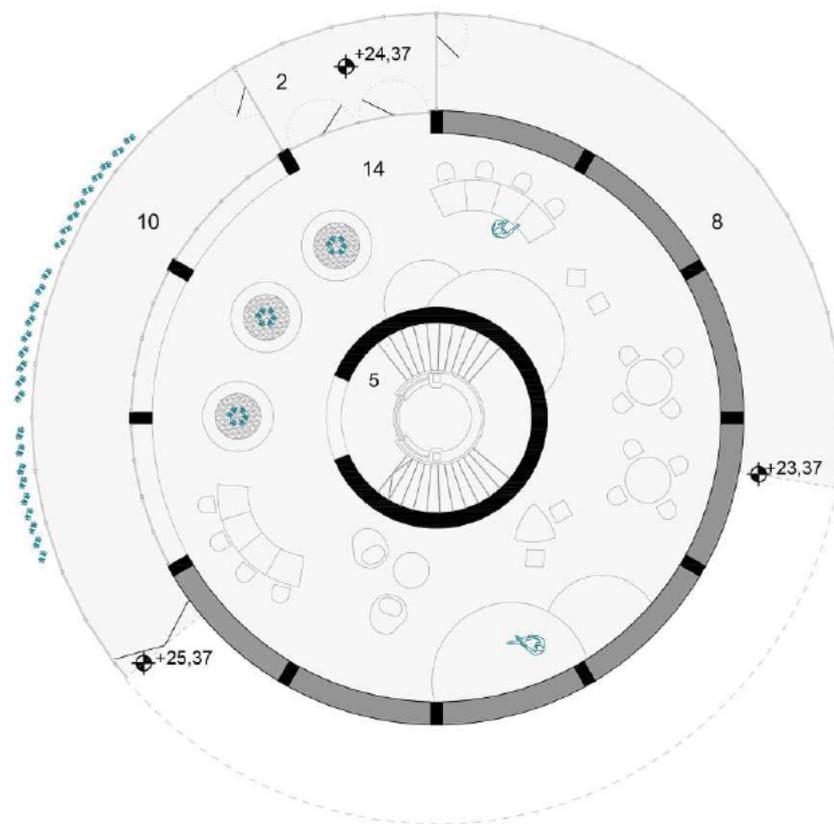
Grundriss 4.Obergeschoss
